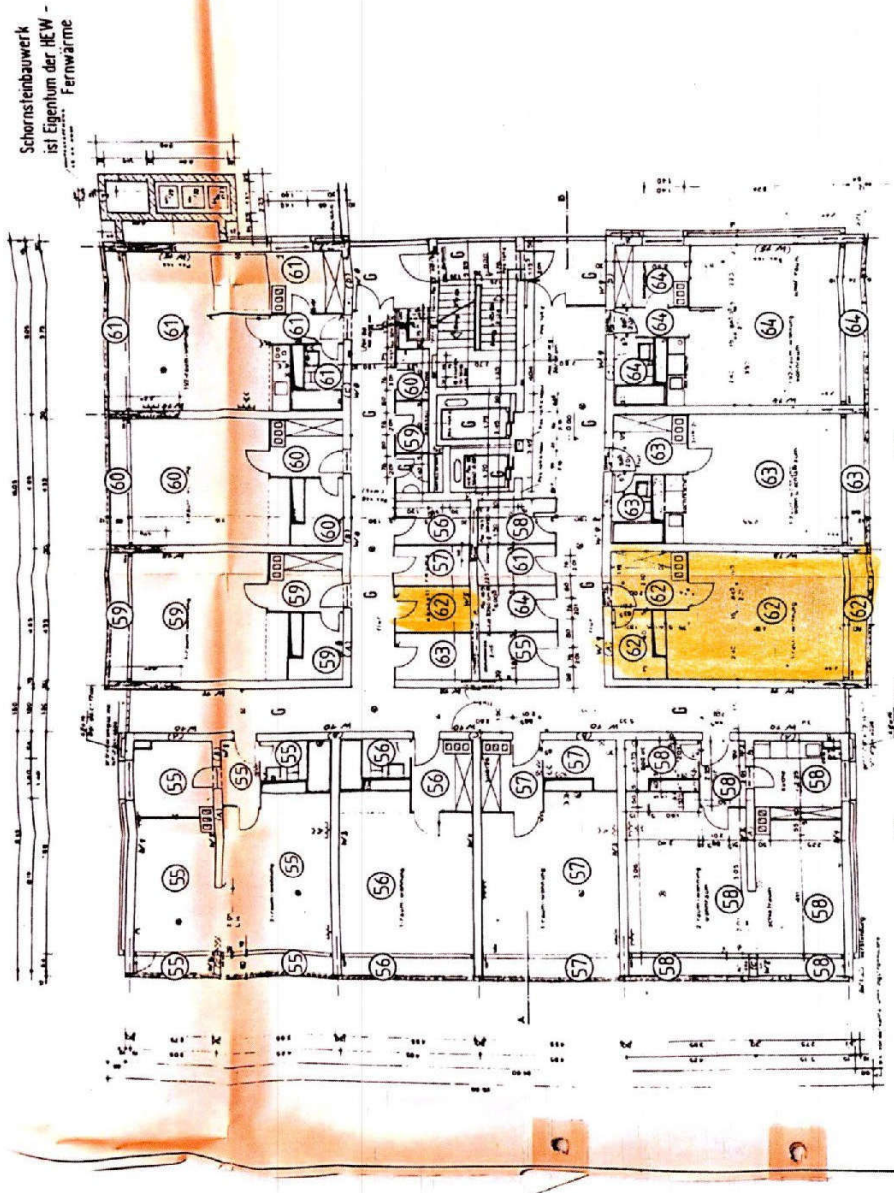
Gesamtplan 5.OG mit Kennzeichnung Bewertungsobjekt mit Abstellraum
